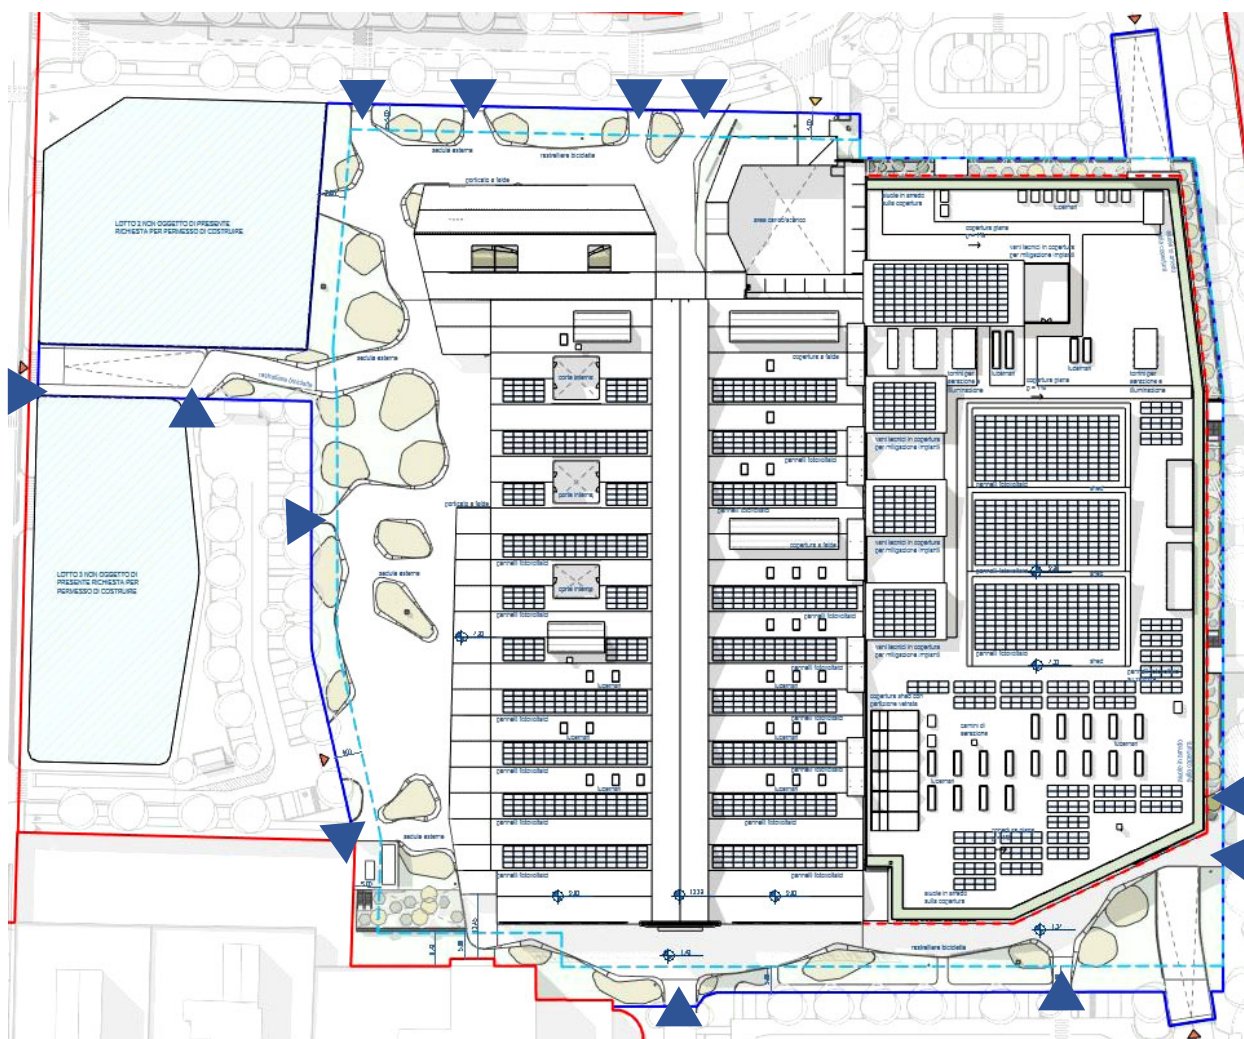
Planimetria del Lotto 1 con accessi ciclopedonali
